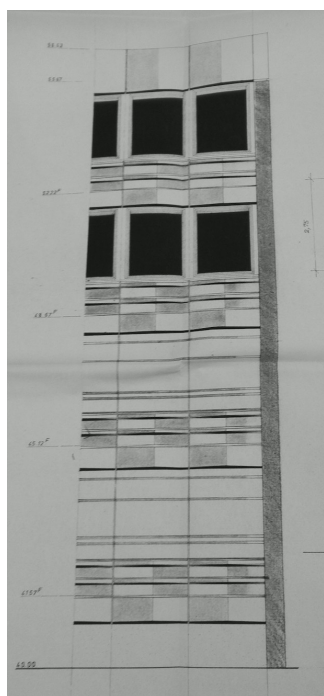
Angle entre la façade et le pignon d'un bâtiment isolé. ADIV1307W60.
